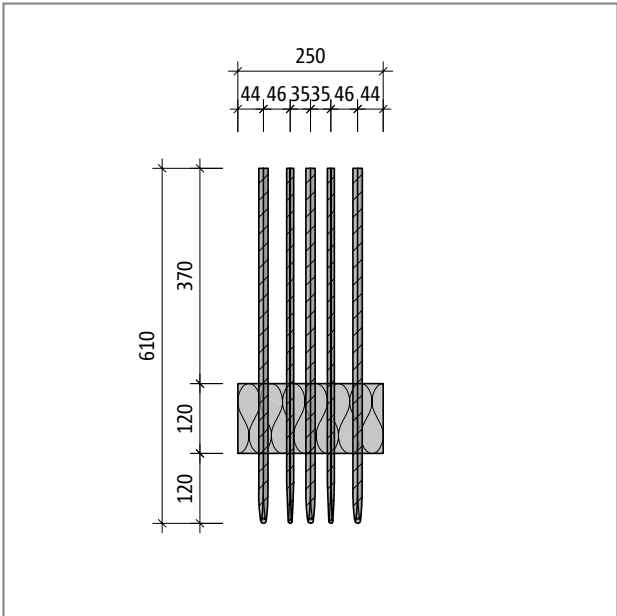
Schöck Isokorb® tipo ABXT: sezione longitudinale del prodotto
